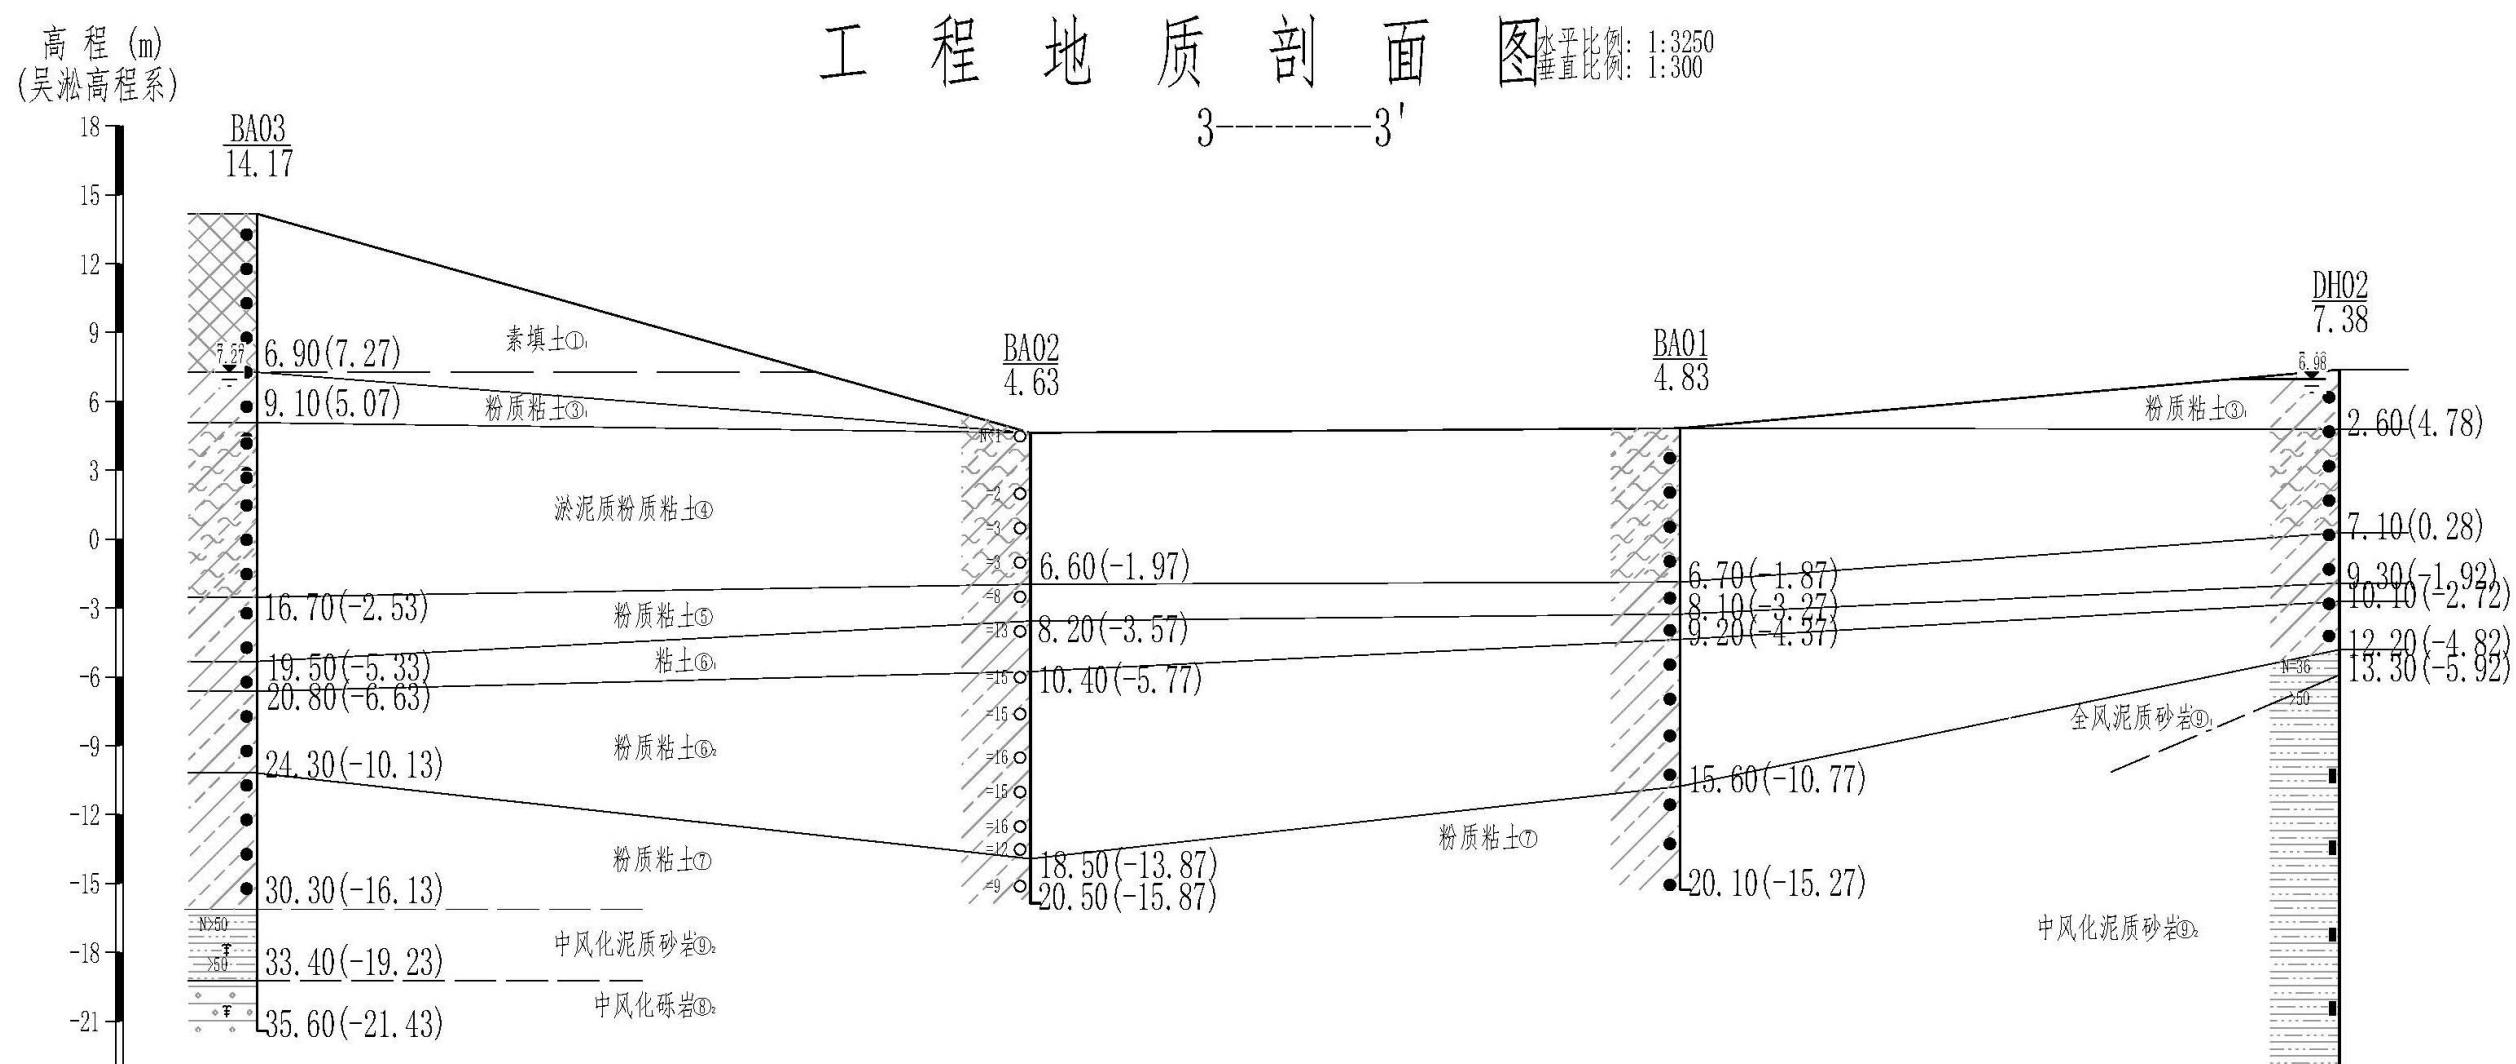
杨家湾船闸工程地质剖面图 (一)
